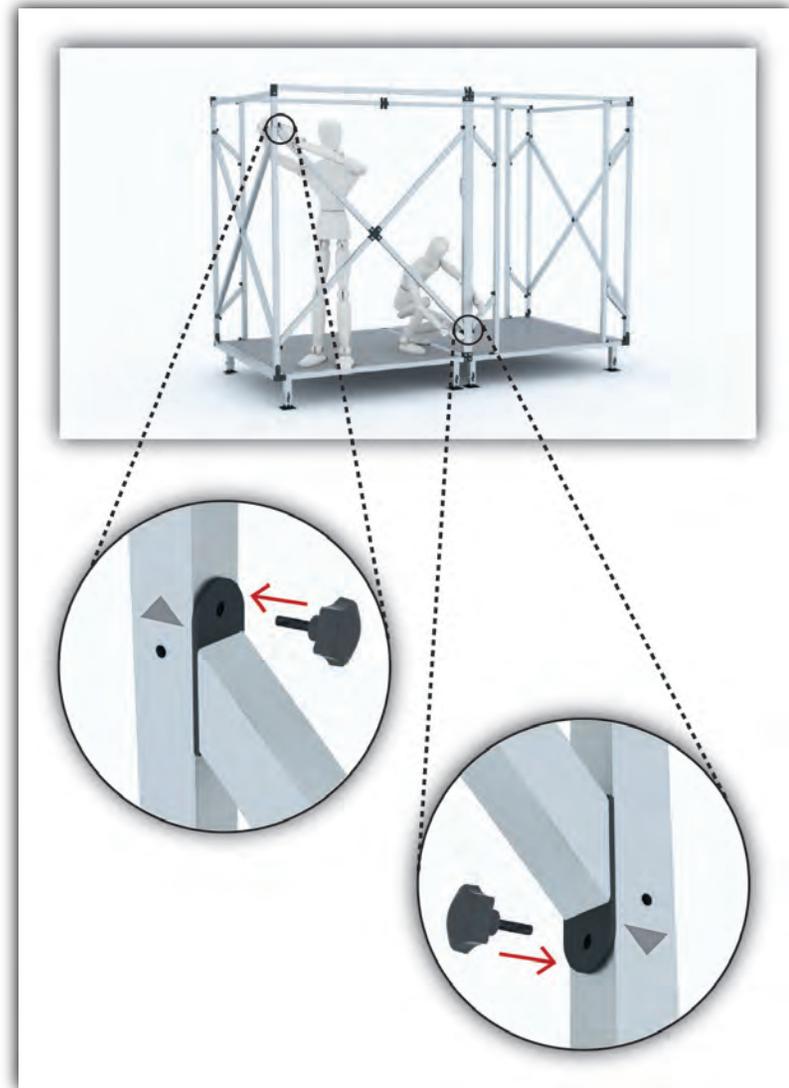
Ensamble de contraventeo desmontable con la columna central y muro por medio de tornillos con empuñadura.
